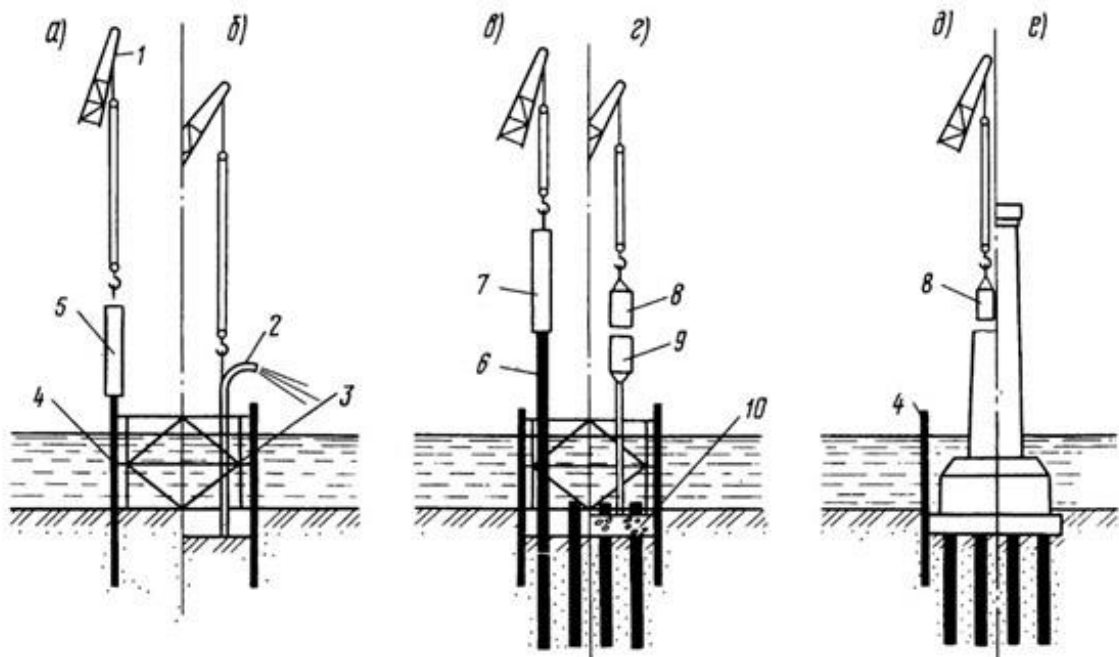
Послідовність будівництва пального фундаменту із заглибленим у ґрунт ростверком:
